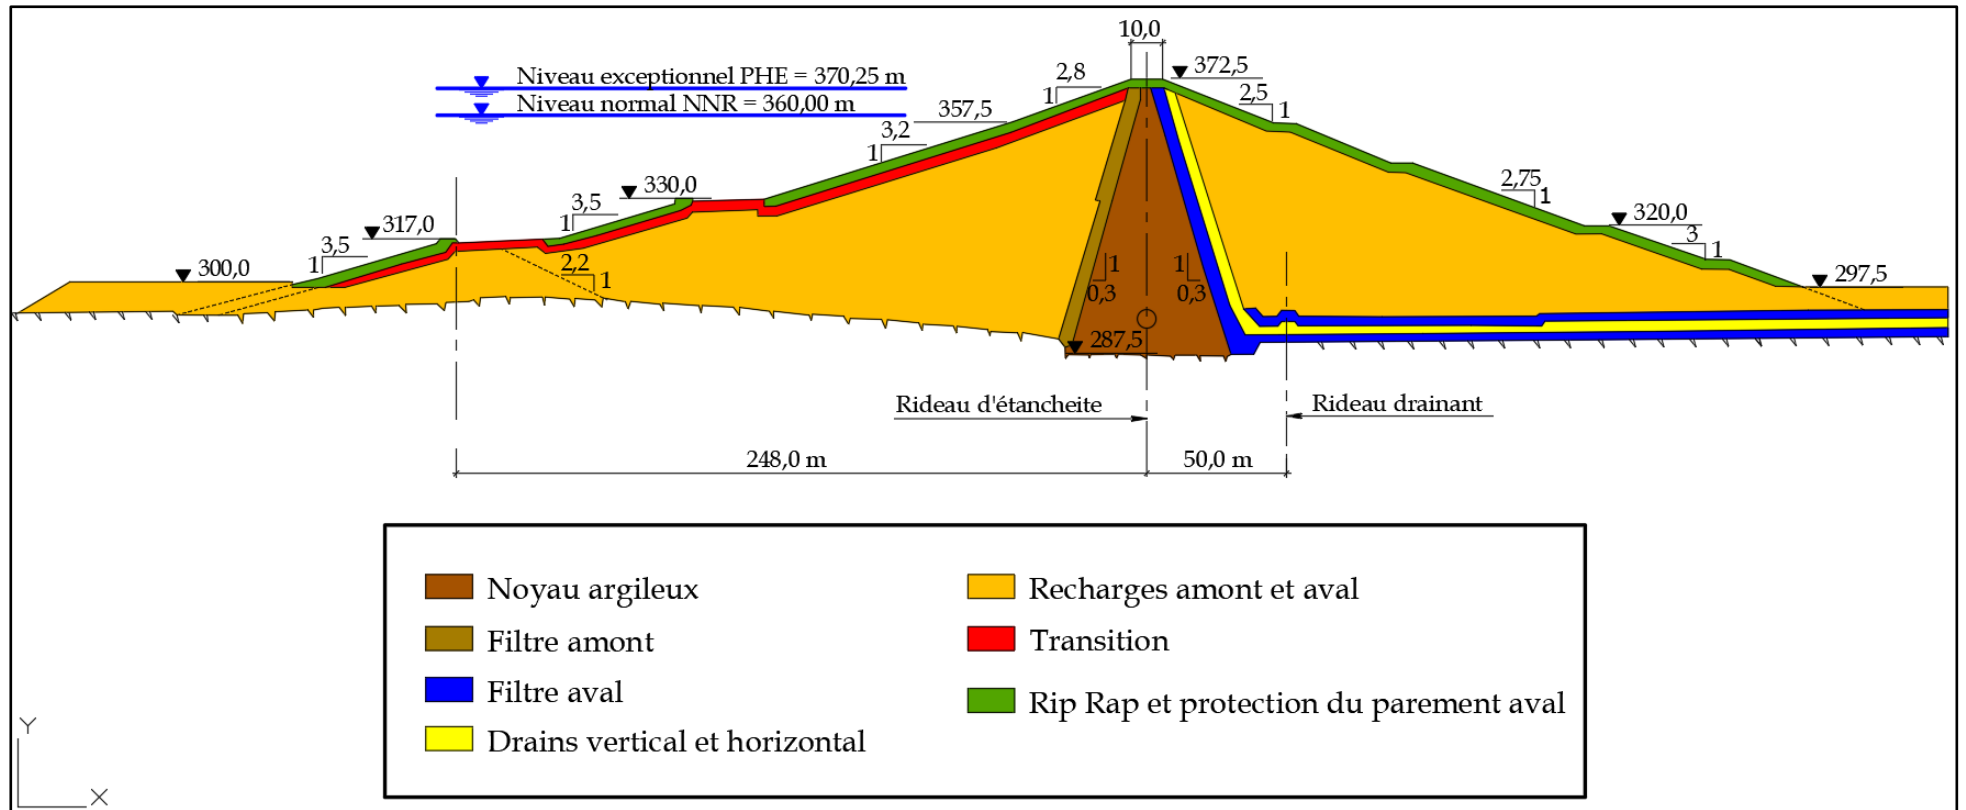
Coupe en travers du barrage Hammam Debagh (source : ANBT (ex ANB), 1985)
